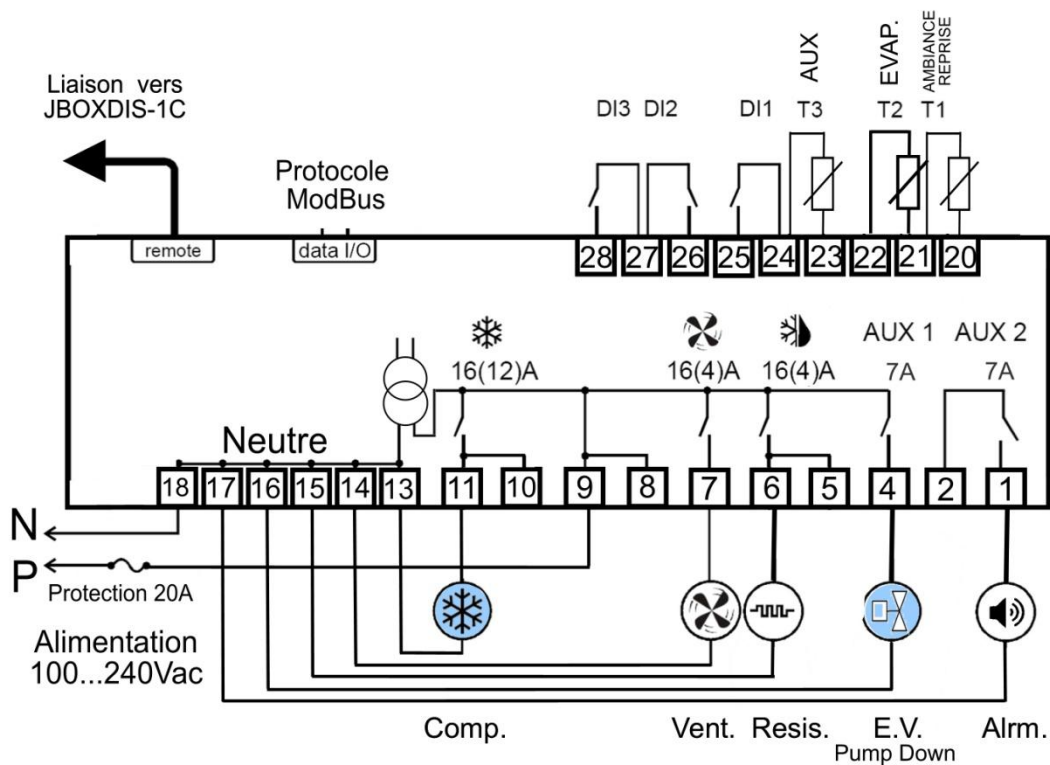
Schéma de câblage pour le pilotage d'un groupe avec « Pump Down »
